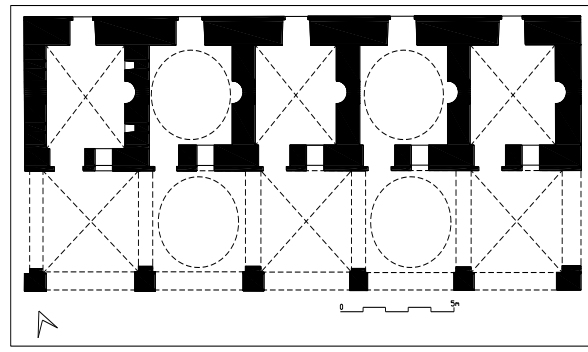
مسقط أفقي (الطابق الثالث) (الباحث 2019؛ بعد، Bageri and (Pitsilis)
